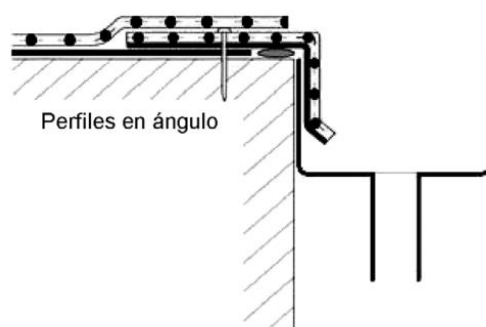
Detalle de entrega a paramento utilizando “Perfil PVC peto alto”.
